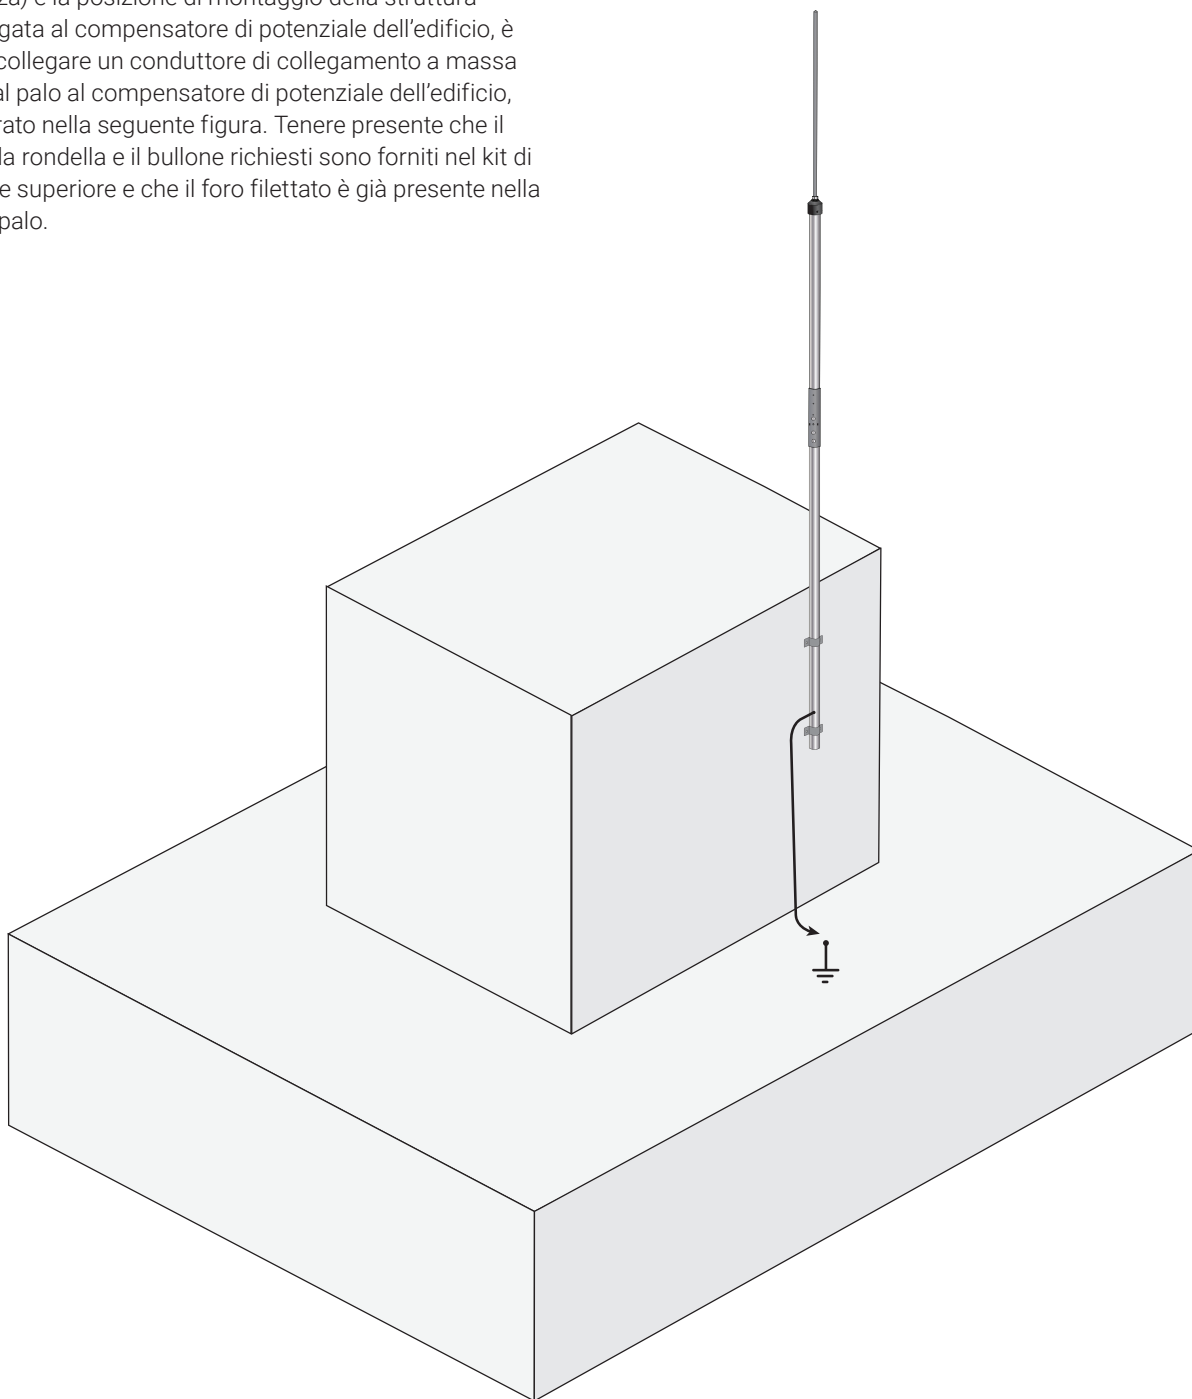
Collegamento del conduttore di collegamento a massa alla sezione inferiore del palo
